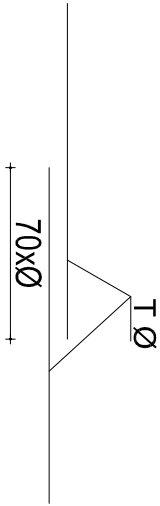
DETAIL FACONNAGE DES CADRES ET DES EPINGLES
